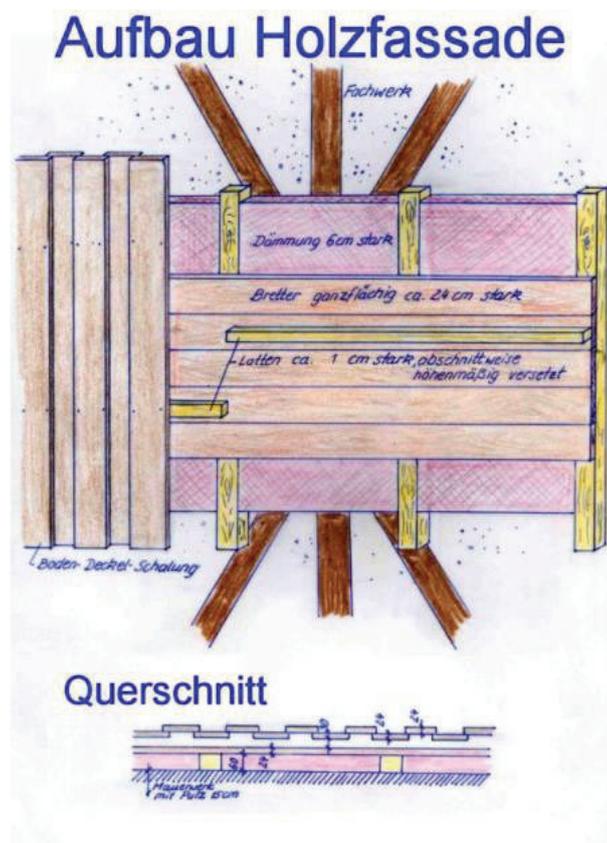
Schematische Darstellung einer Holzfassade an einem Fachwerkhaus (aus Reiter & Zahn 2006)
